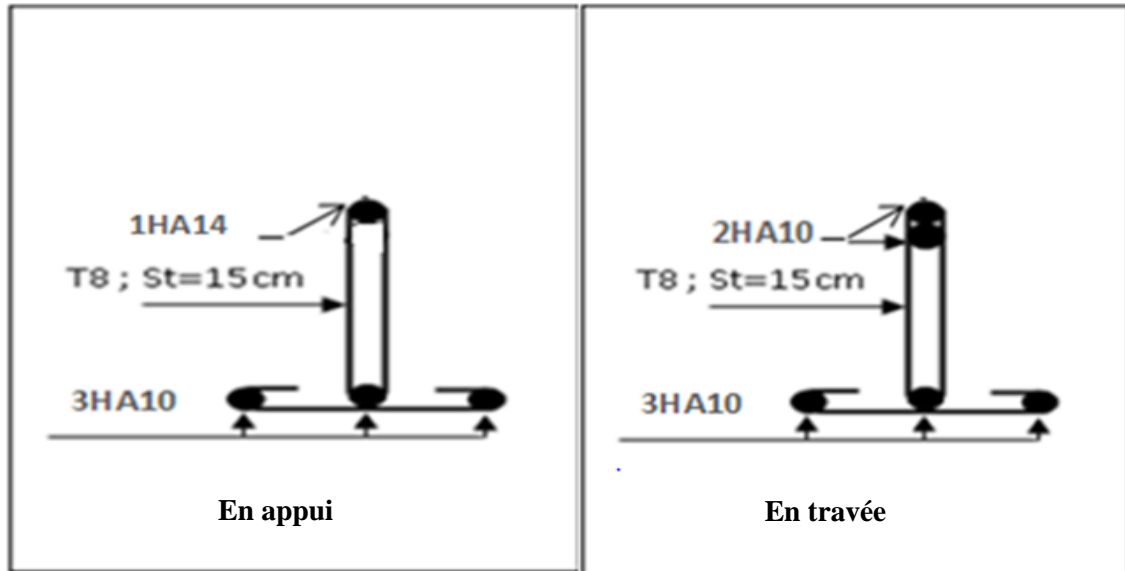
Schéma de ferrailage des nervures plancher étage.
